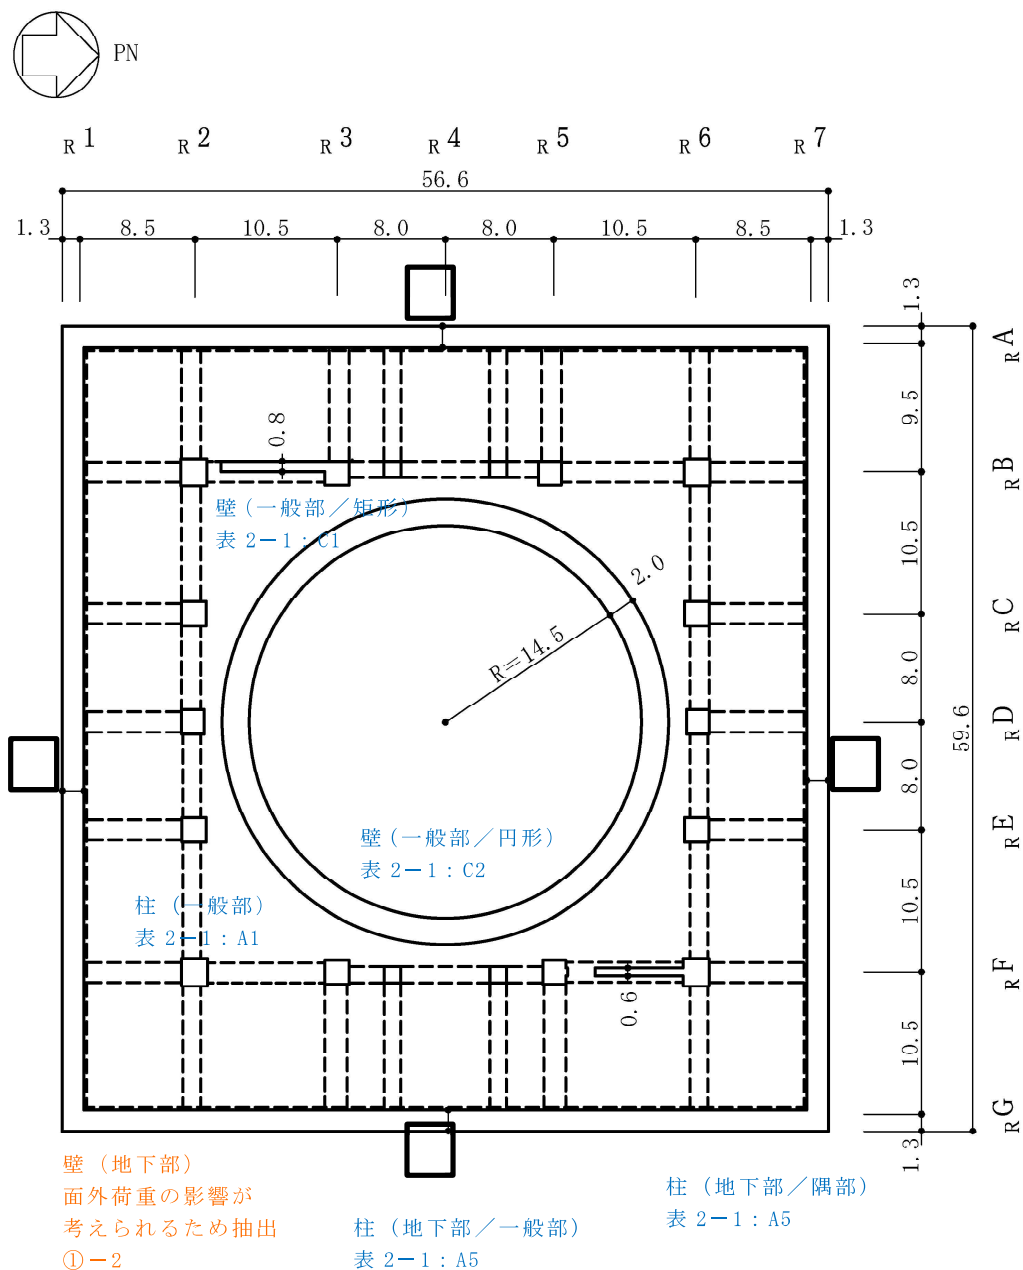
原子炉建屋の概略平面図（B2F, T. M. S. L. -1.7m）（2/8）（単位：m）
